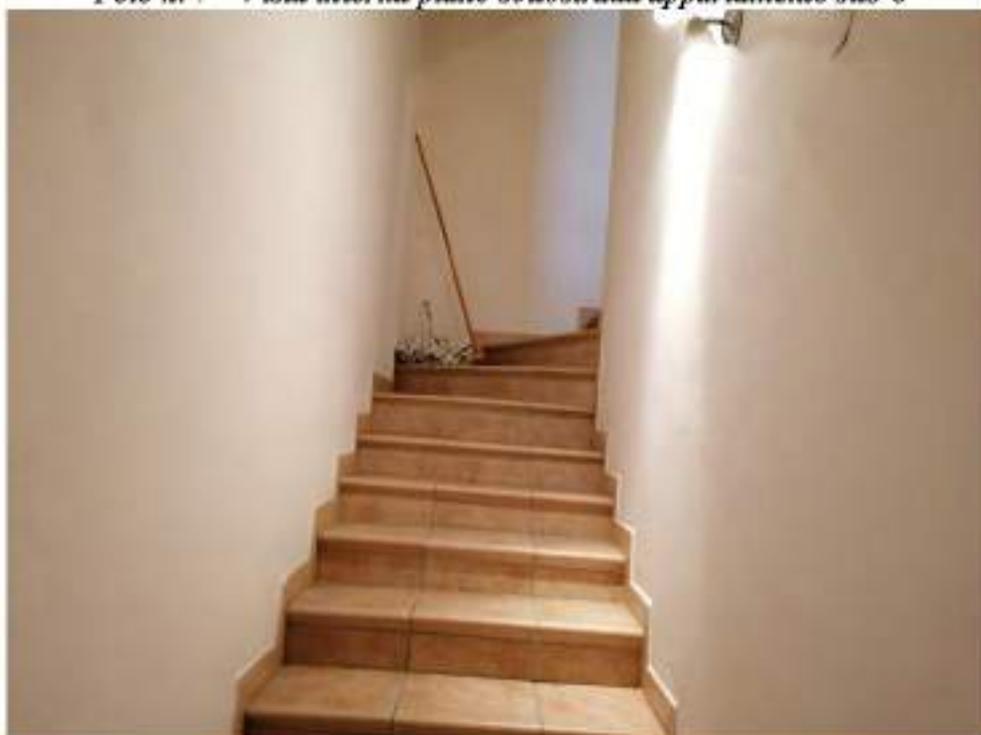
Vista interna piano sottostrada appartamento sub 8
